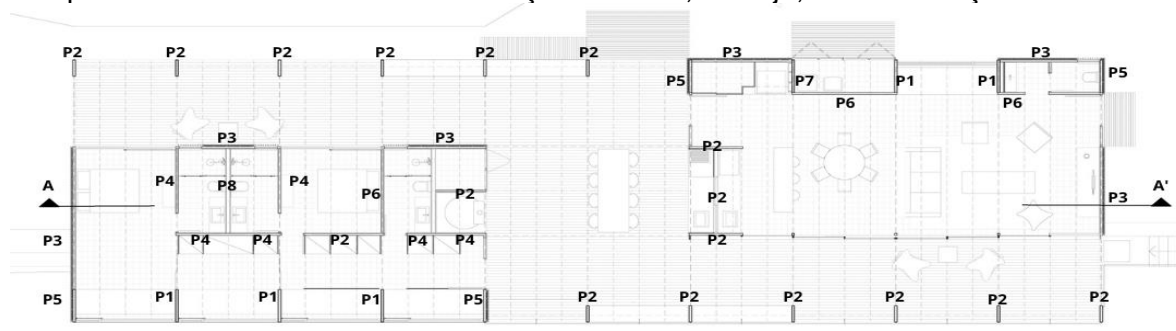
Planta simplificada com indicação dos tipos de paredes externas e internas, MAPA Arquitectos (adaptado), 2023
